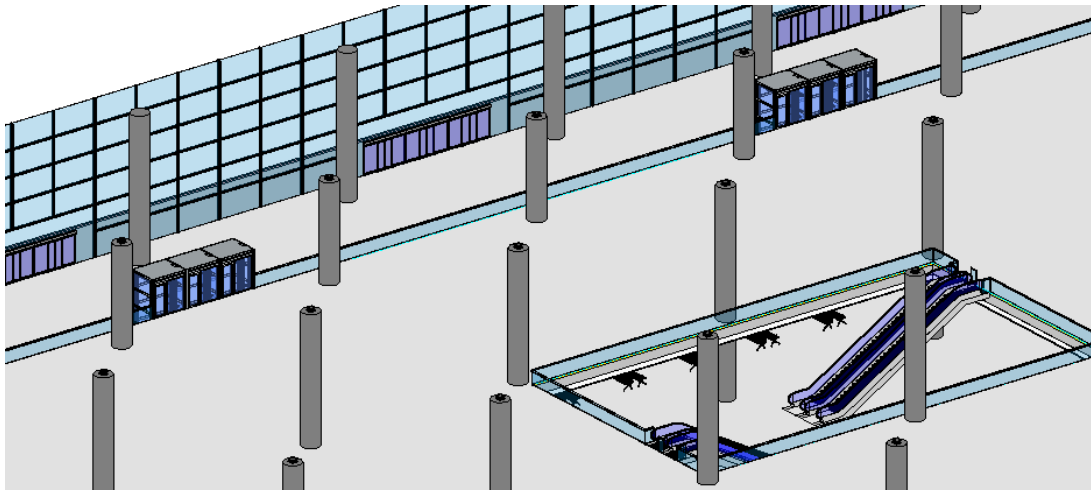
Detalle del balcón de la planta superior junto con el núcleo de escaleras mecánicas y sus correspondientes barandillas.
